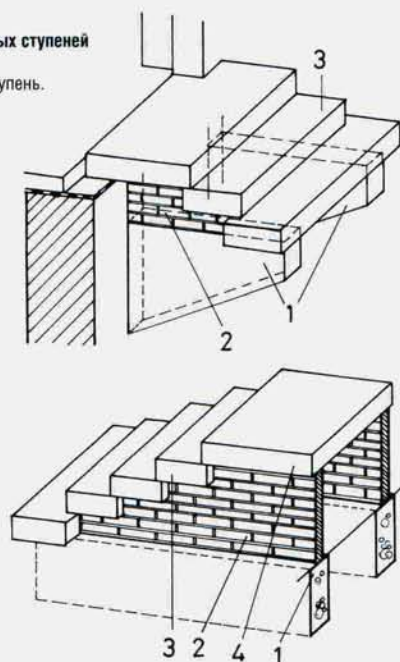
Наружная крылечная лестница с опорой на две стены и фундамент
